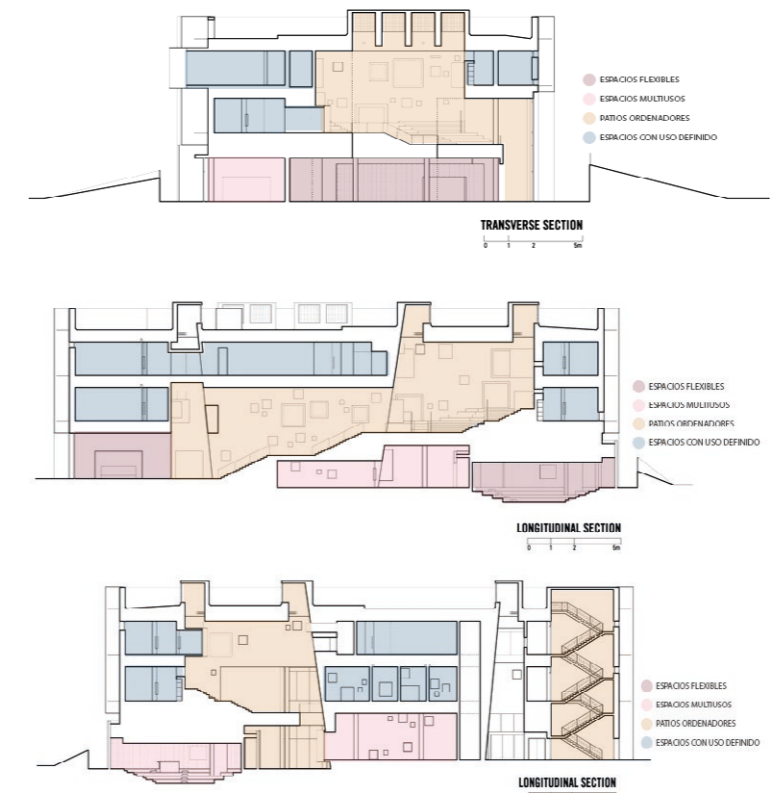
Secciones longitudinales y transversales. Adaptado de Plataforma de Arquitectura, 2015
